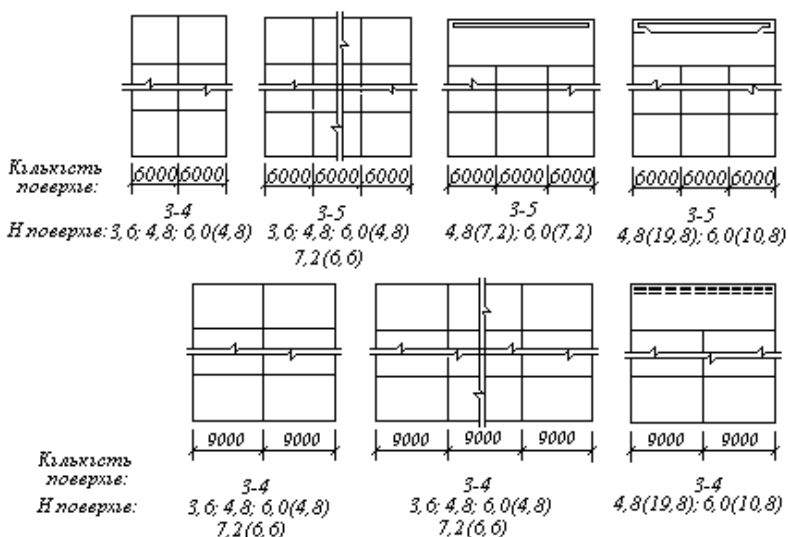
Уніфіковані габаритні схеми багатоповерхових промислових будівель
